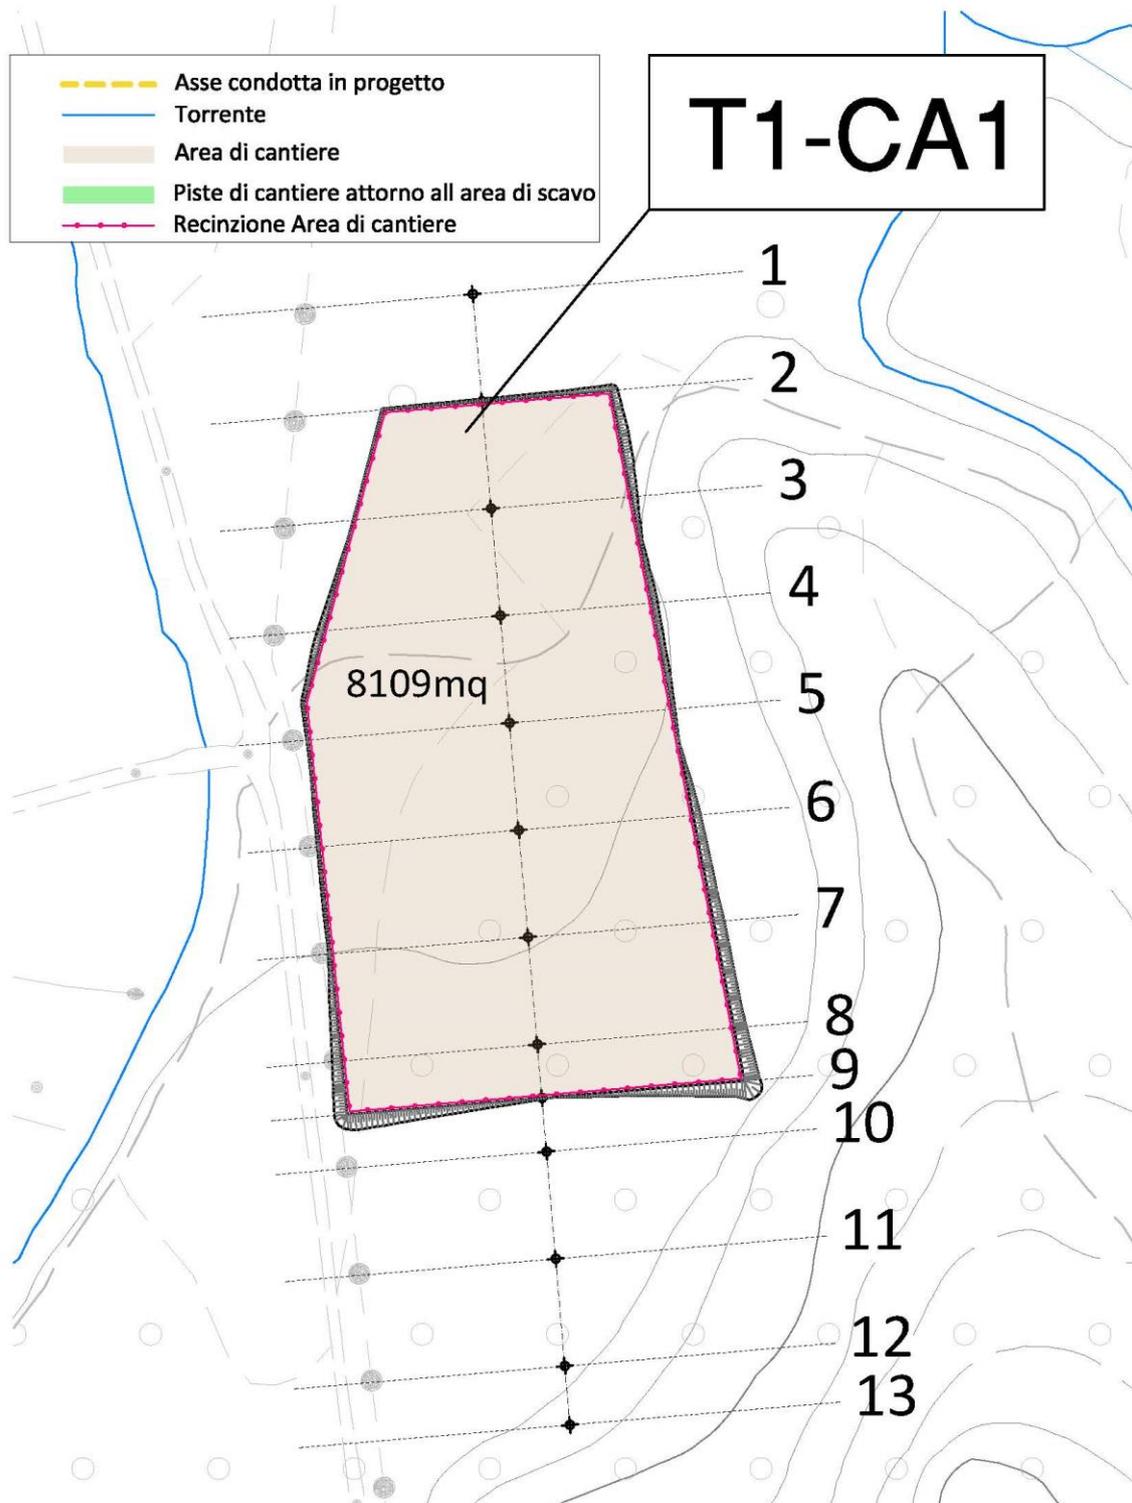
Inquadramento planimetrico area cantiere T1-CA1.
